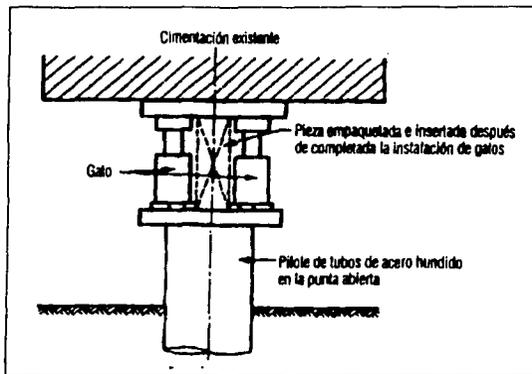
Recimentación con pilotes de tubos de acero ⁽⁶⁾
